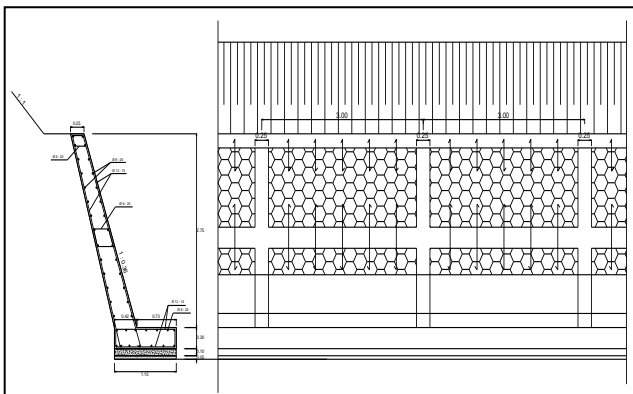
Tipikal Tembok Penahan Tanah Beton Pada Daerah Timbunan
